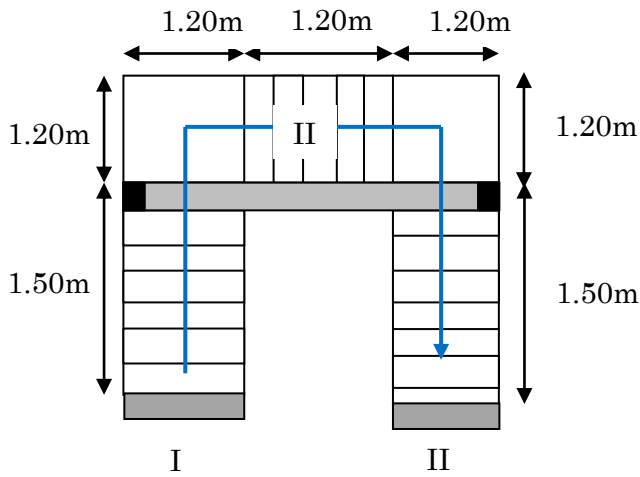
Vue en plan de l'escalier d'étage courant
